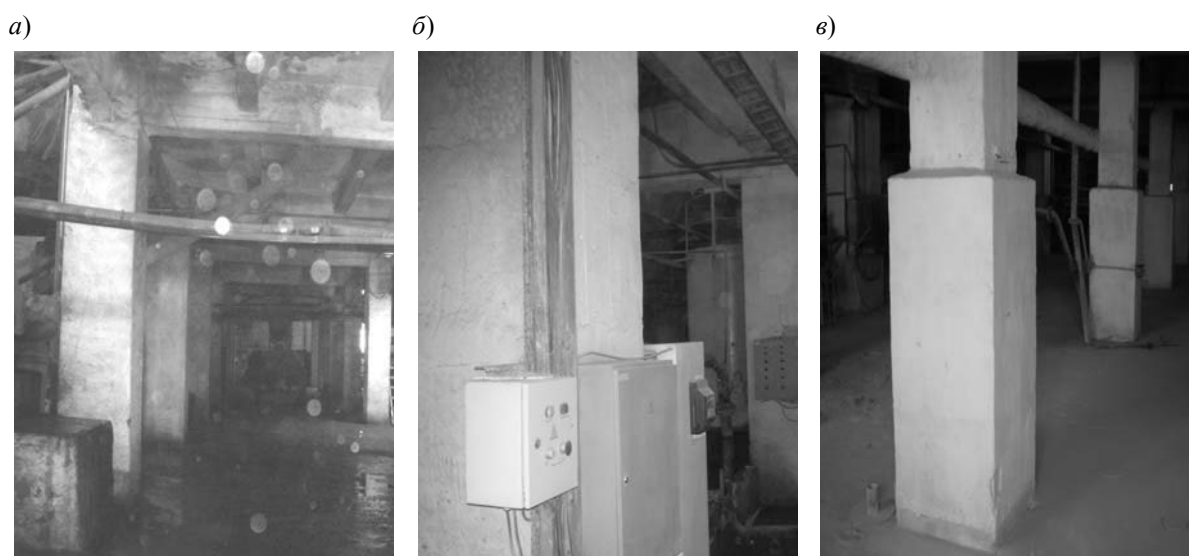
Вид на восстановленные и усиленные железобетонные колонны подготовительного отделения цеха АЦИ ОАО «Кричевцементношифер»: а – усиленные железобетонные колонны 1-го этажа; б – усиленные железобетонные колонны 2-го этажа; в – местное усиление железобетонных колонн 2-го этажа
